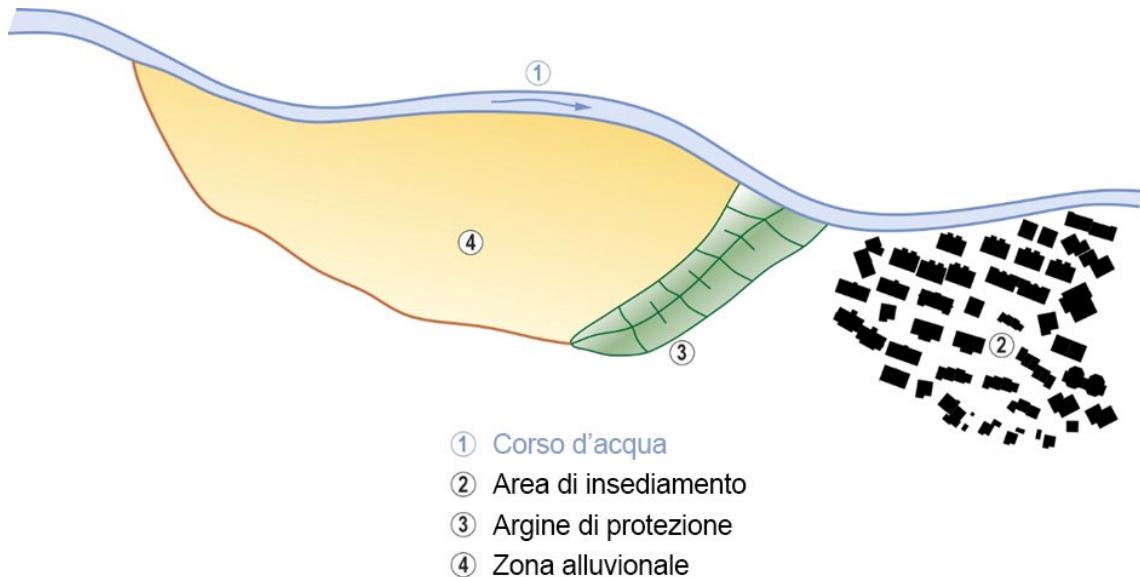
Argine di protezione con funzione di argine longitudinale.
